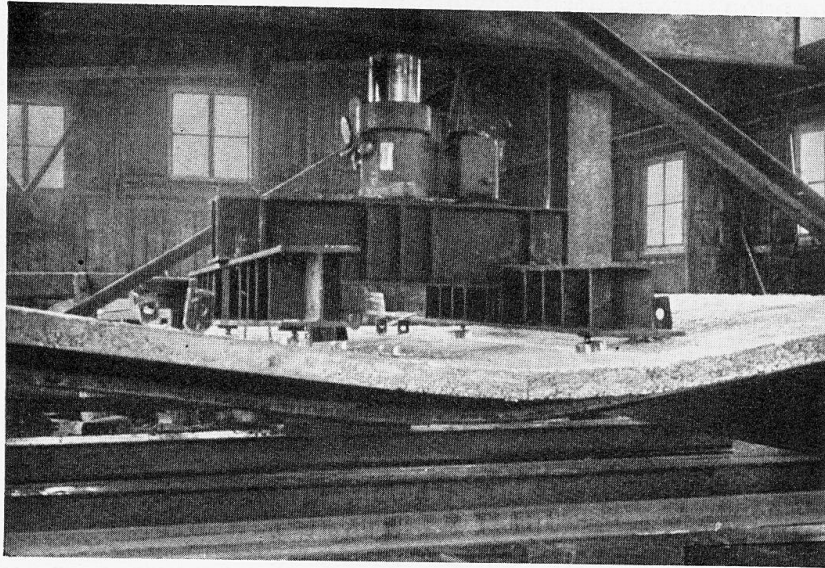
Dispositif d'essai avec poutres, après l'essai.
